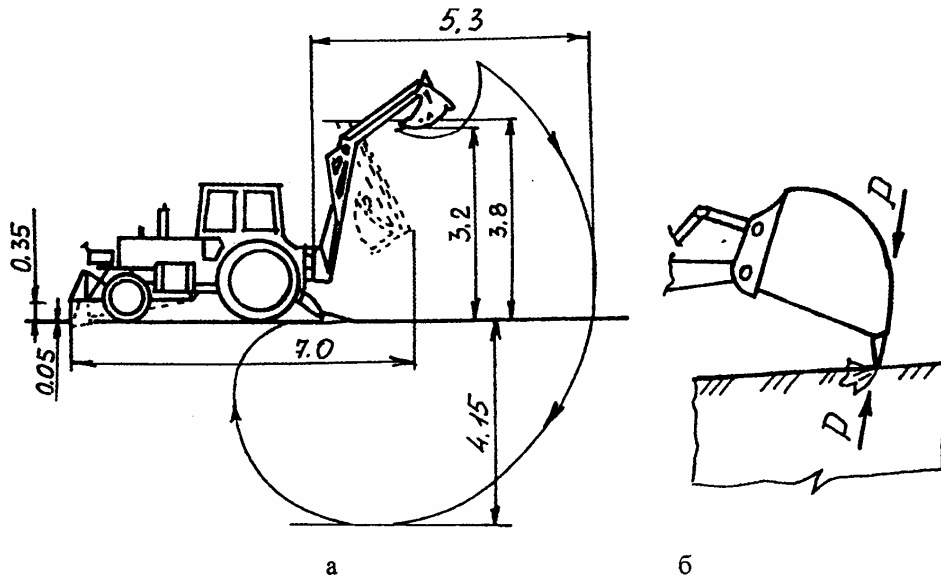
Конструктивні розміри і траєкторія руху ковша екскаватора зворотного копання (а) і початок роботи машини на поверхні масиву (б)
